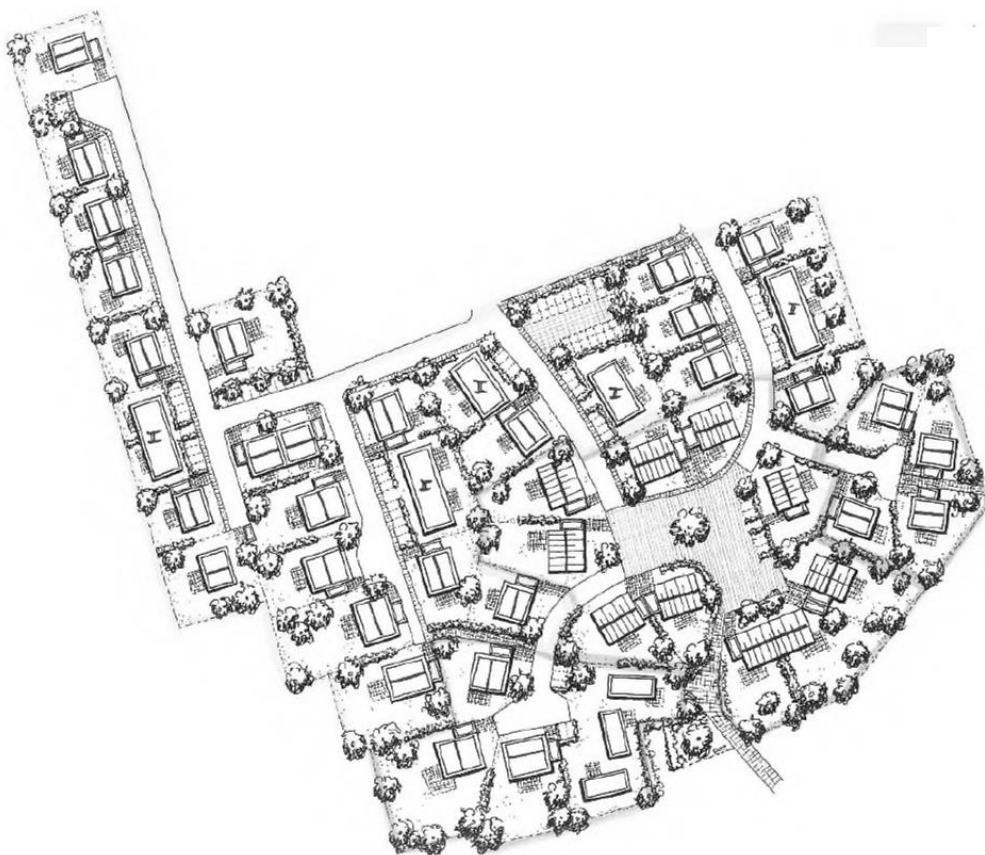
städtebaulicher Entwurf (Kreisstadt Merzig)
